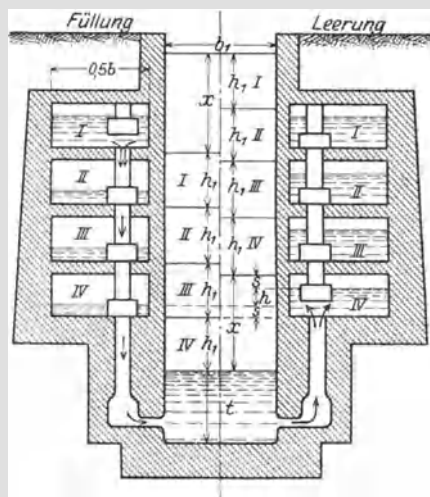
Sparschleuse mit 4 Sparbecken. Vorgang der Füllung und Leerung.
